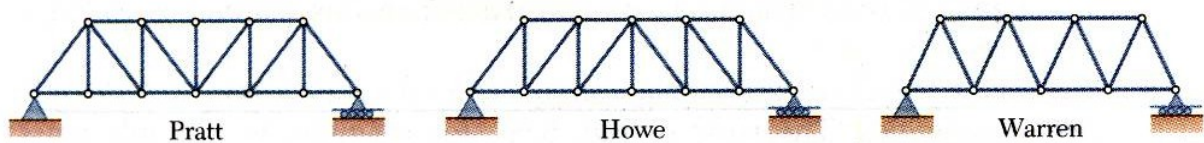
Exemple de poutres ( ou de fermes) trapézoïdales en treillis
